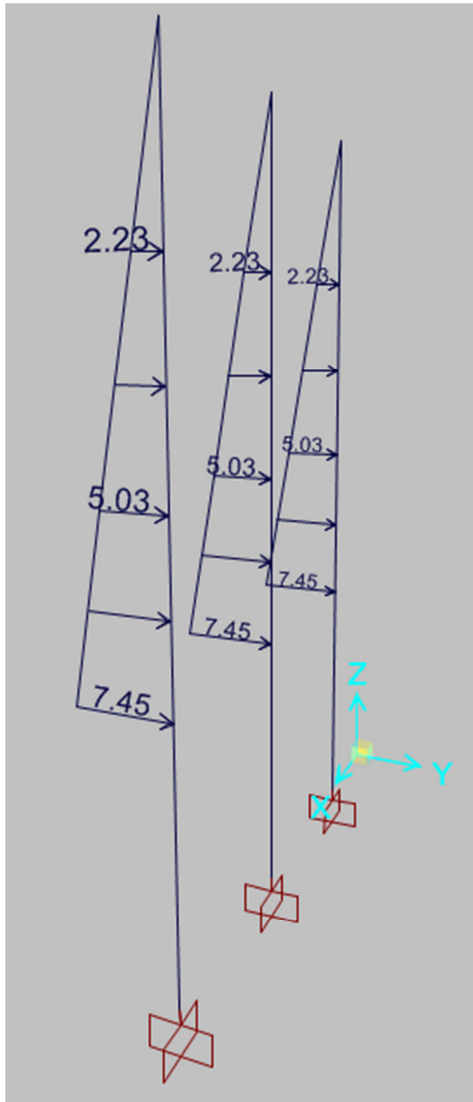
Empuje de tierras ejercido sobre el muro (ton/m).
